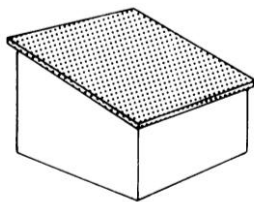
Пристройка или односкатная крыша (Stanley Tools)
